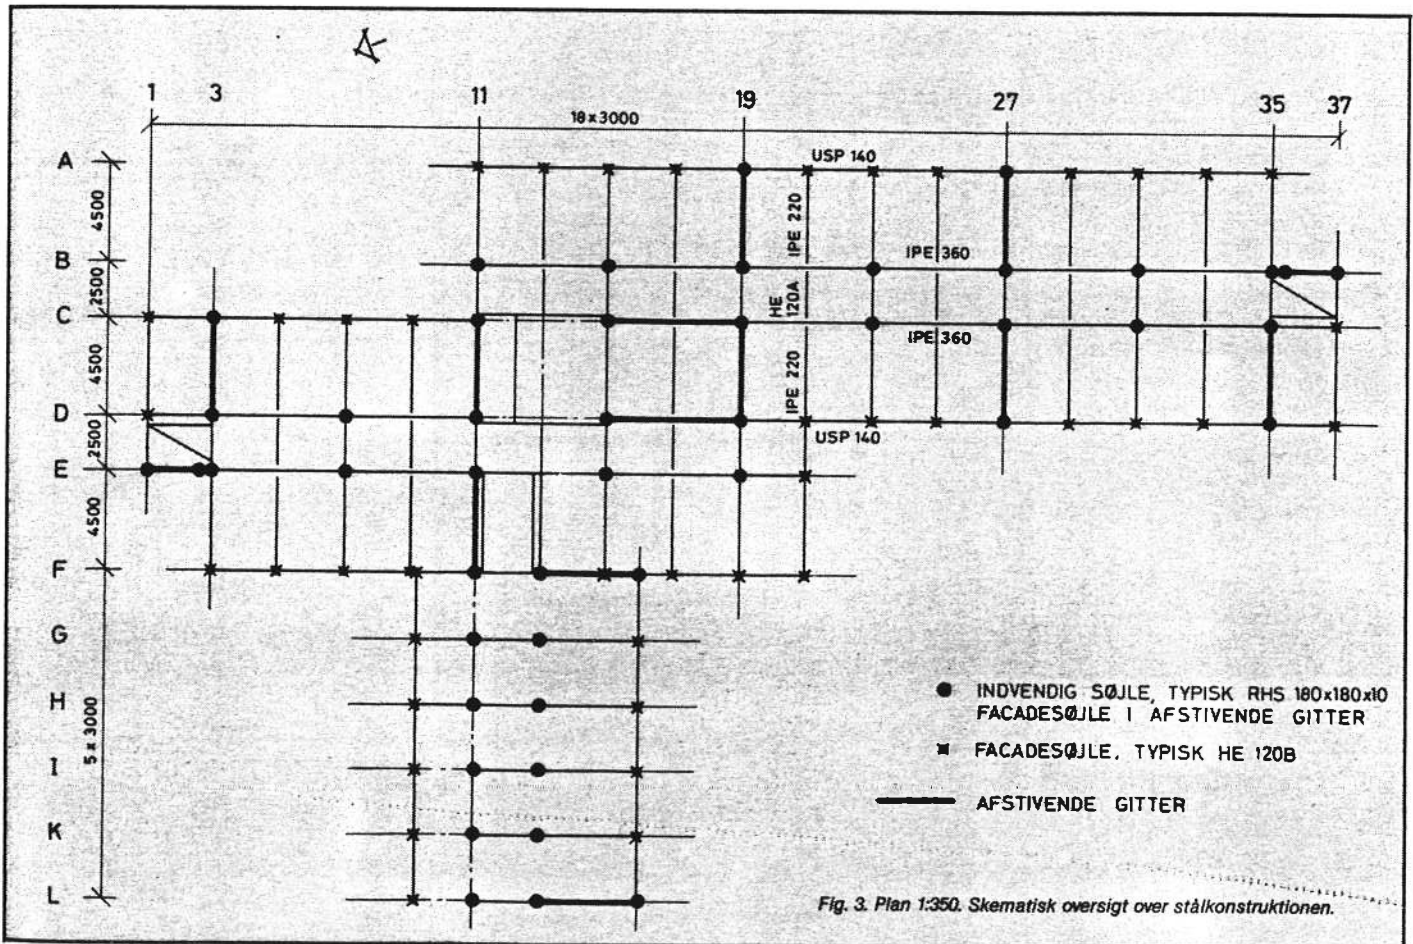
Plan 1:350. Skematisk oversigt over stålkonstruktionen.
